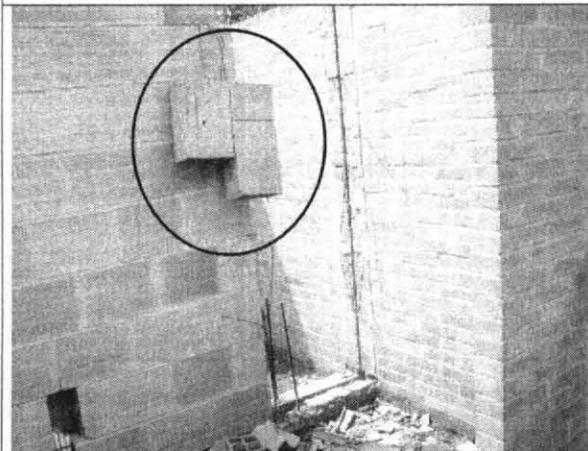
Pérdida de piezas de mampostería de algunos muros.
